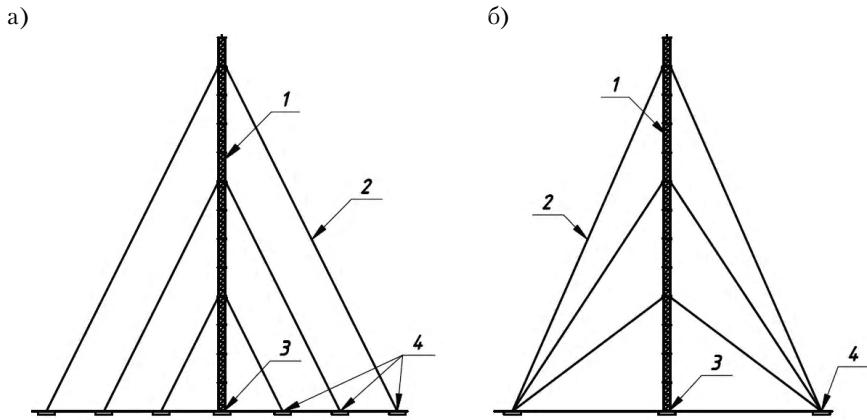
Геометрические схемы мачт: а) с оттяжками, сходящимися у отдельных анкерных фундаментов; б) с оттяжками, сходящимися у одного анкерного фундамента.
